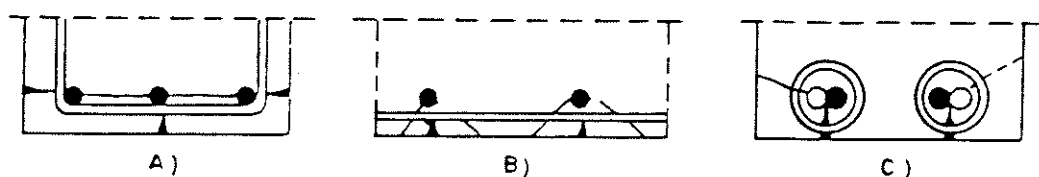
Armadura transversal de confinamento em forma de a) estribos, b) barras transversais e c) espirais.
